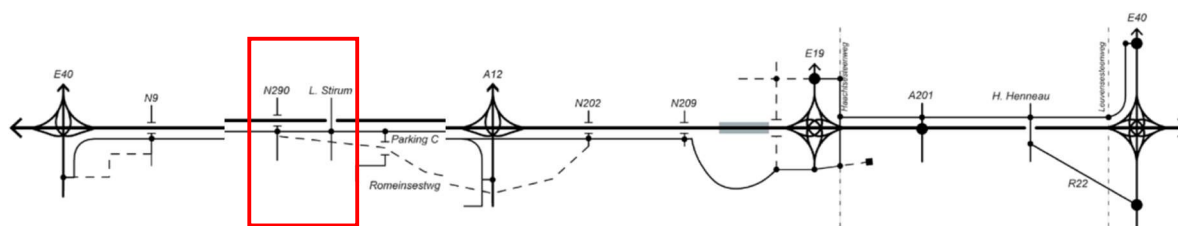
Schéma linéaire G3A3 variante profil longitudinal réduit/pont paysager maximal Wemmel-Jette (depuis la N290 à l'Avenue De Limburg Stirum)
